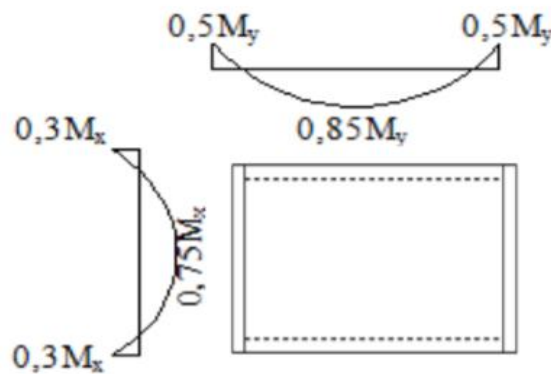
Schéma du panneau de la dalle appuie sur 4 coté.
